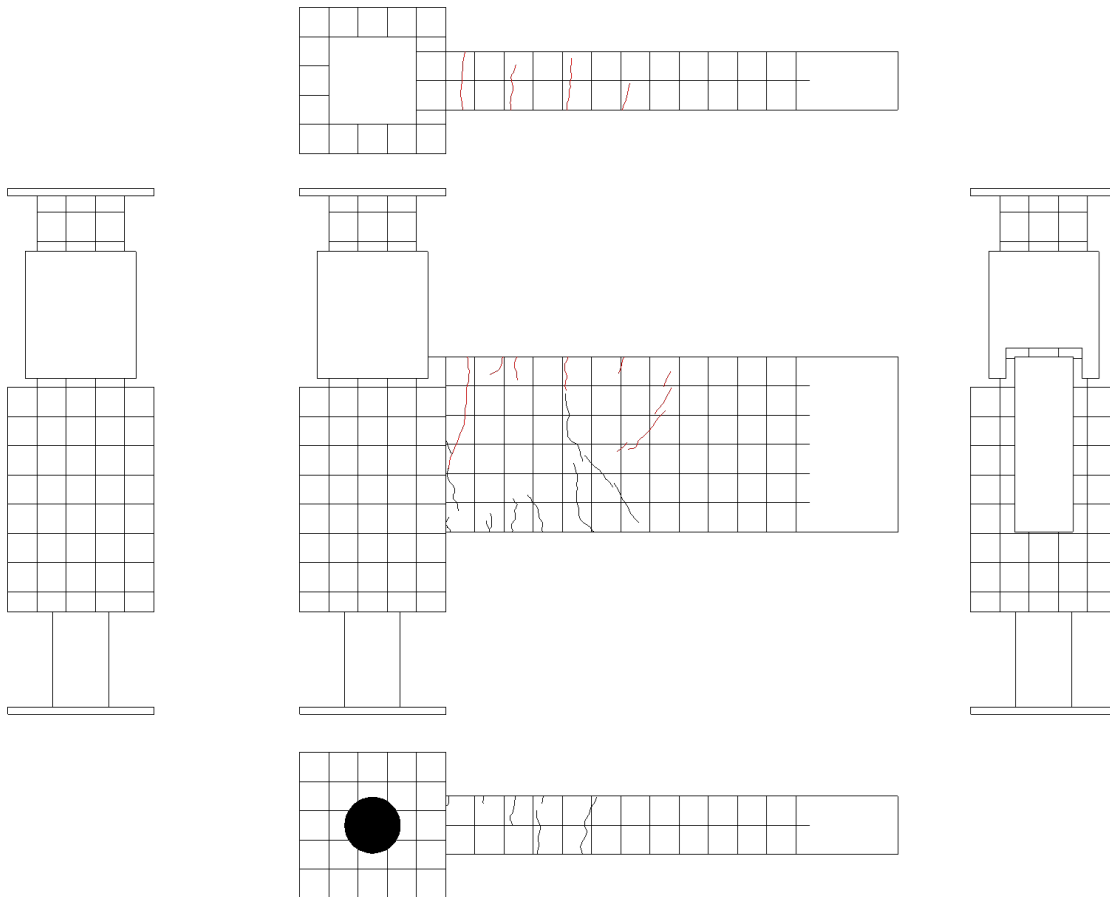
試験体 A-3 ひび割れ状況 (1Cycle)
